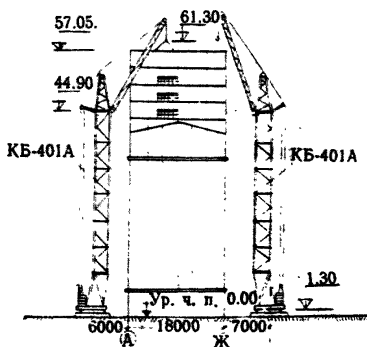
Схема привязки двух башенных кранов КБ-401А для монтажа конструкций рабочего здания
